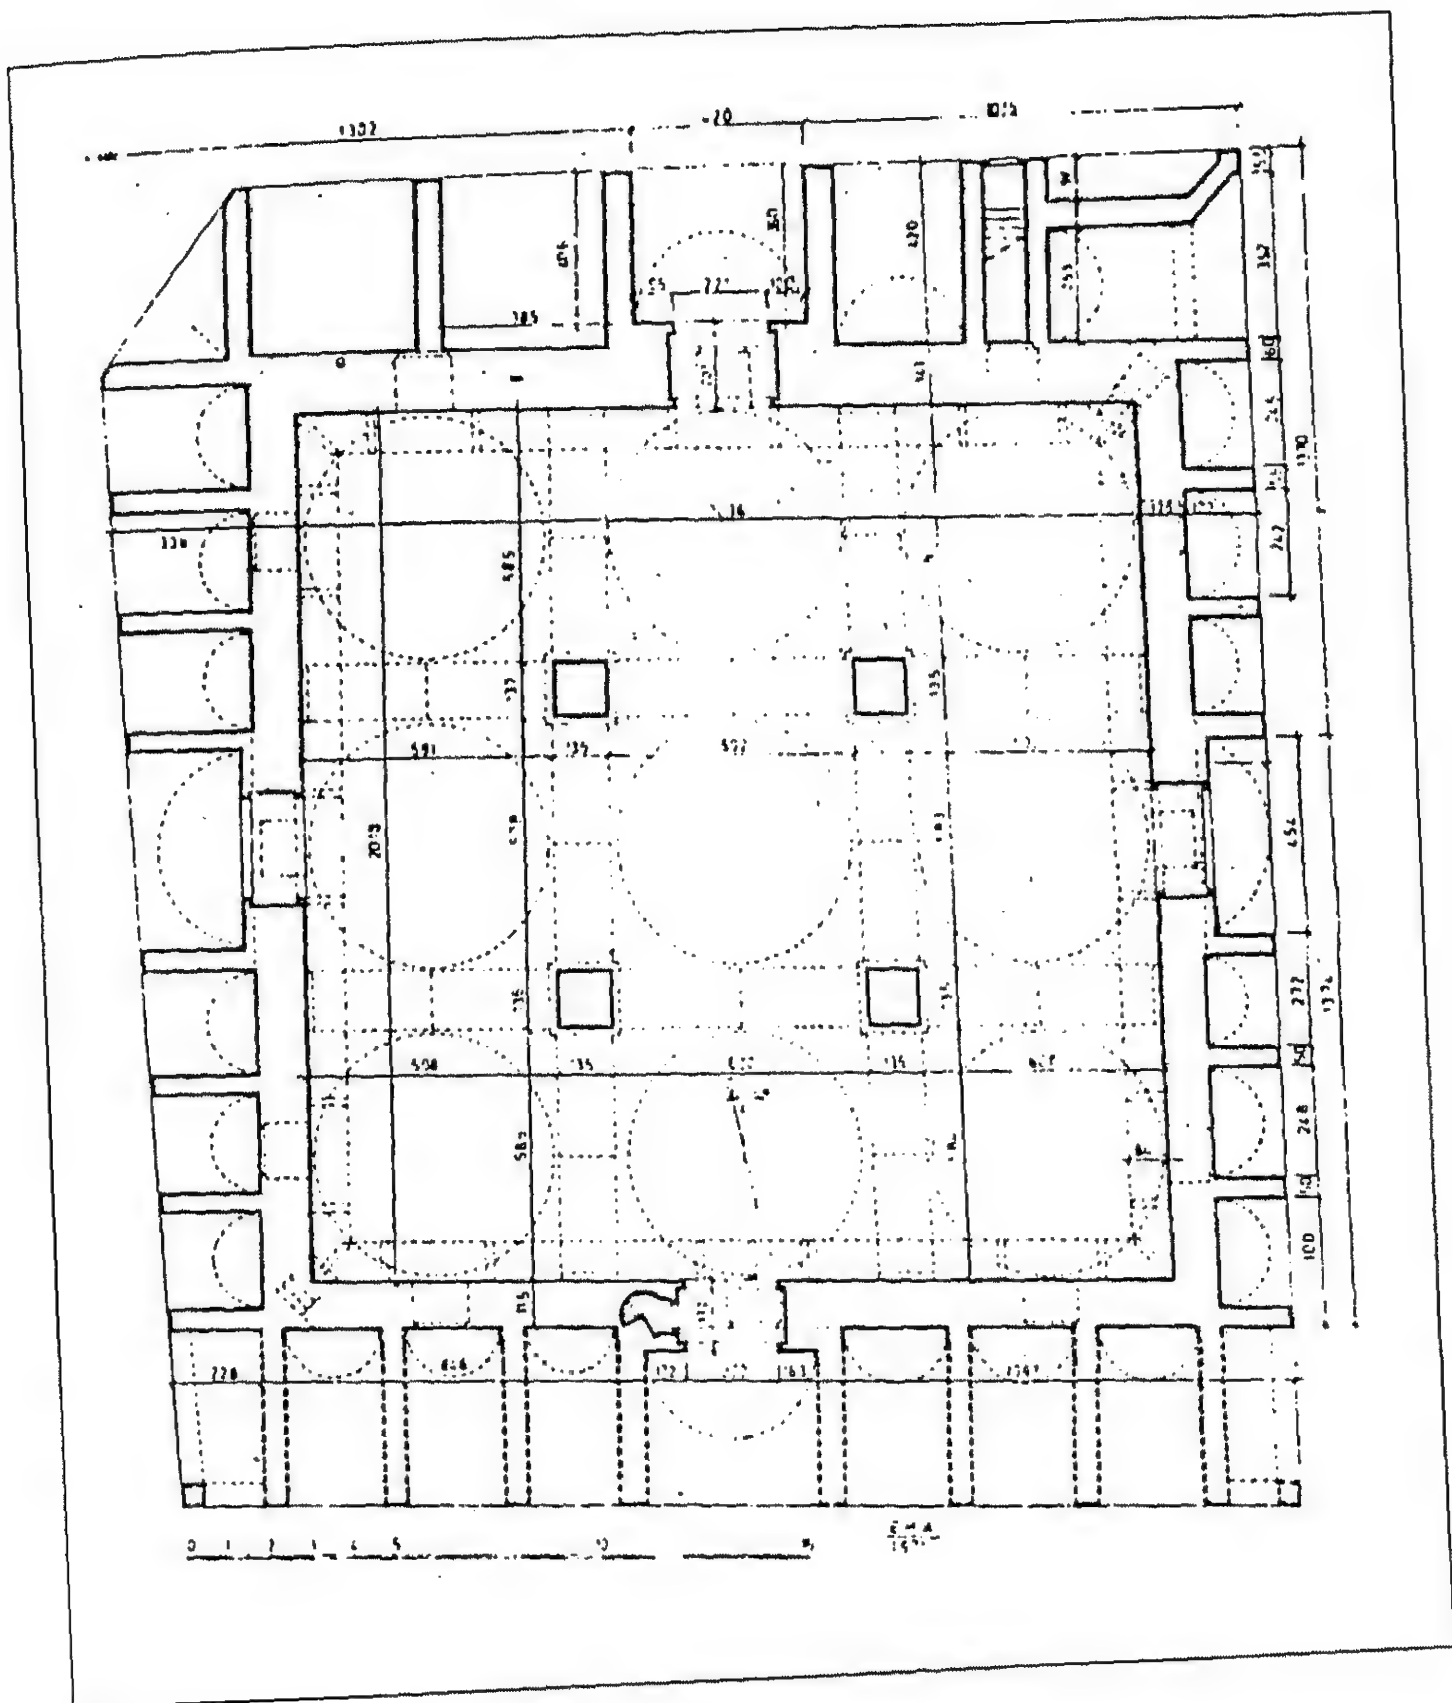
مسقط أفقي لبادستان أدرنه (عن: Cezar).
